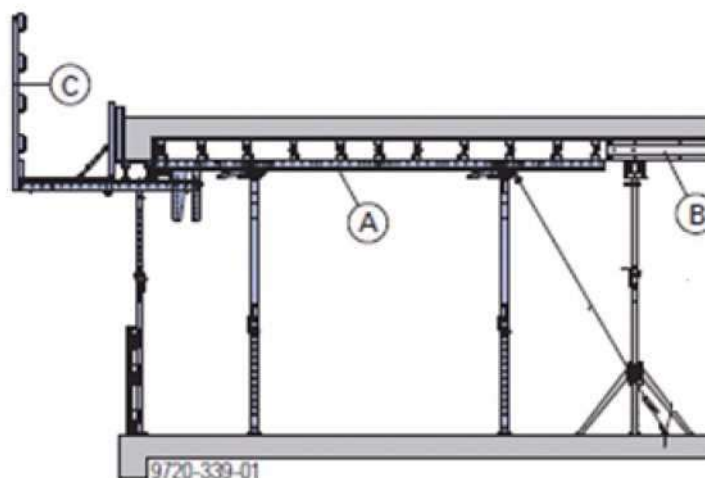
Схема устройства опалубки ж/б балок на краю перекрытия. А, В - опалубка перекрытия; С - ограждение опалубки перекрытия.
